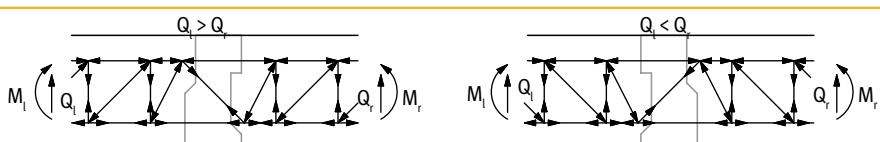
Listverkstruktur for Schöck Isokorb® type K
